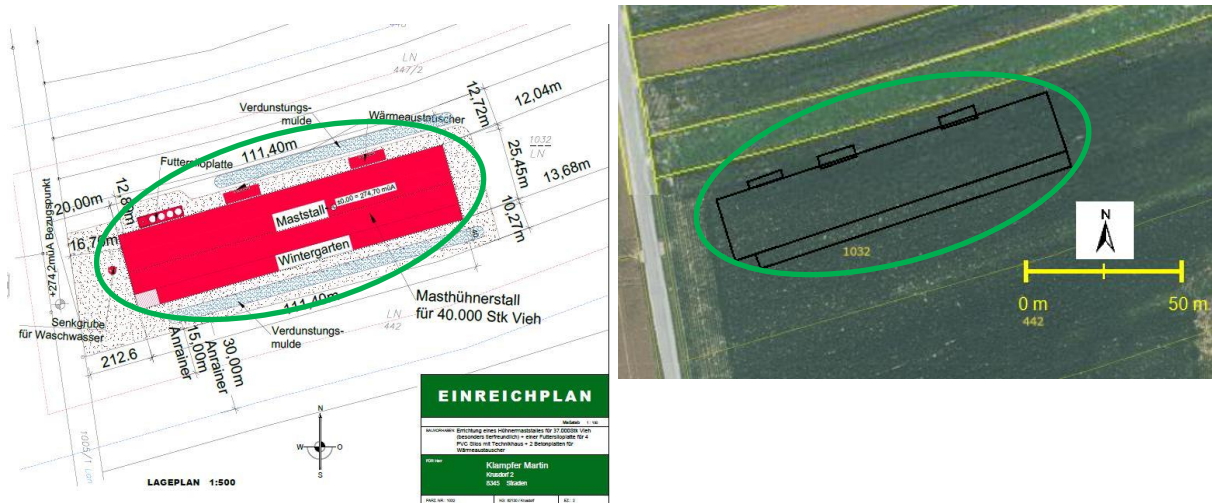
Lageplan und Orthofoto zum Einreichprojekt KLAMPFER (Planfall)
